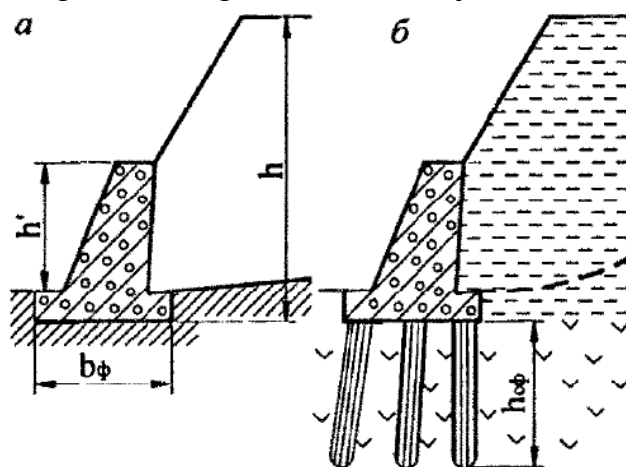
Схема подпорной стенки на прочном основании (а) и на свайном фундаменте (б): h , h' – высота уступа и стенки соответственно; b_{ϕ} – ширина фундамента; h_{ϕ} – глубина забивки свай фундамента
